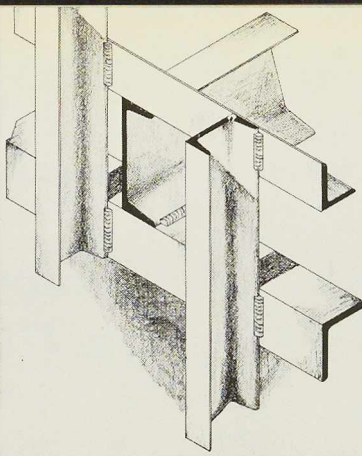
Vue montrant le mode de jonction des panneaux de murs du rez-de-chaussée et du premier étage.
